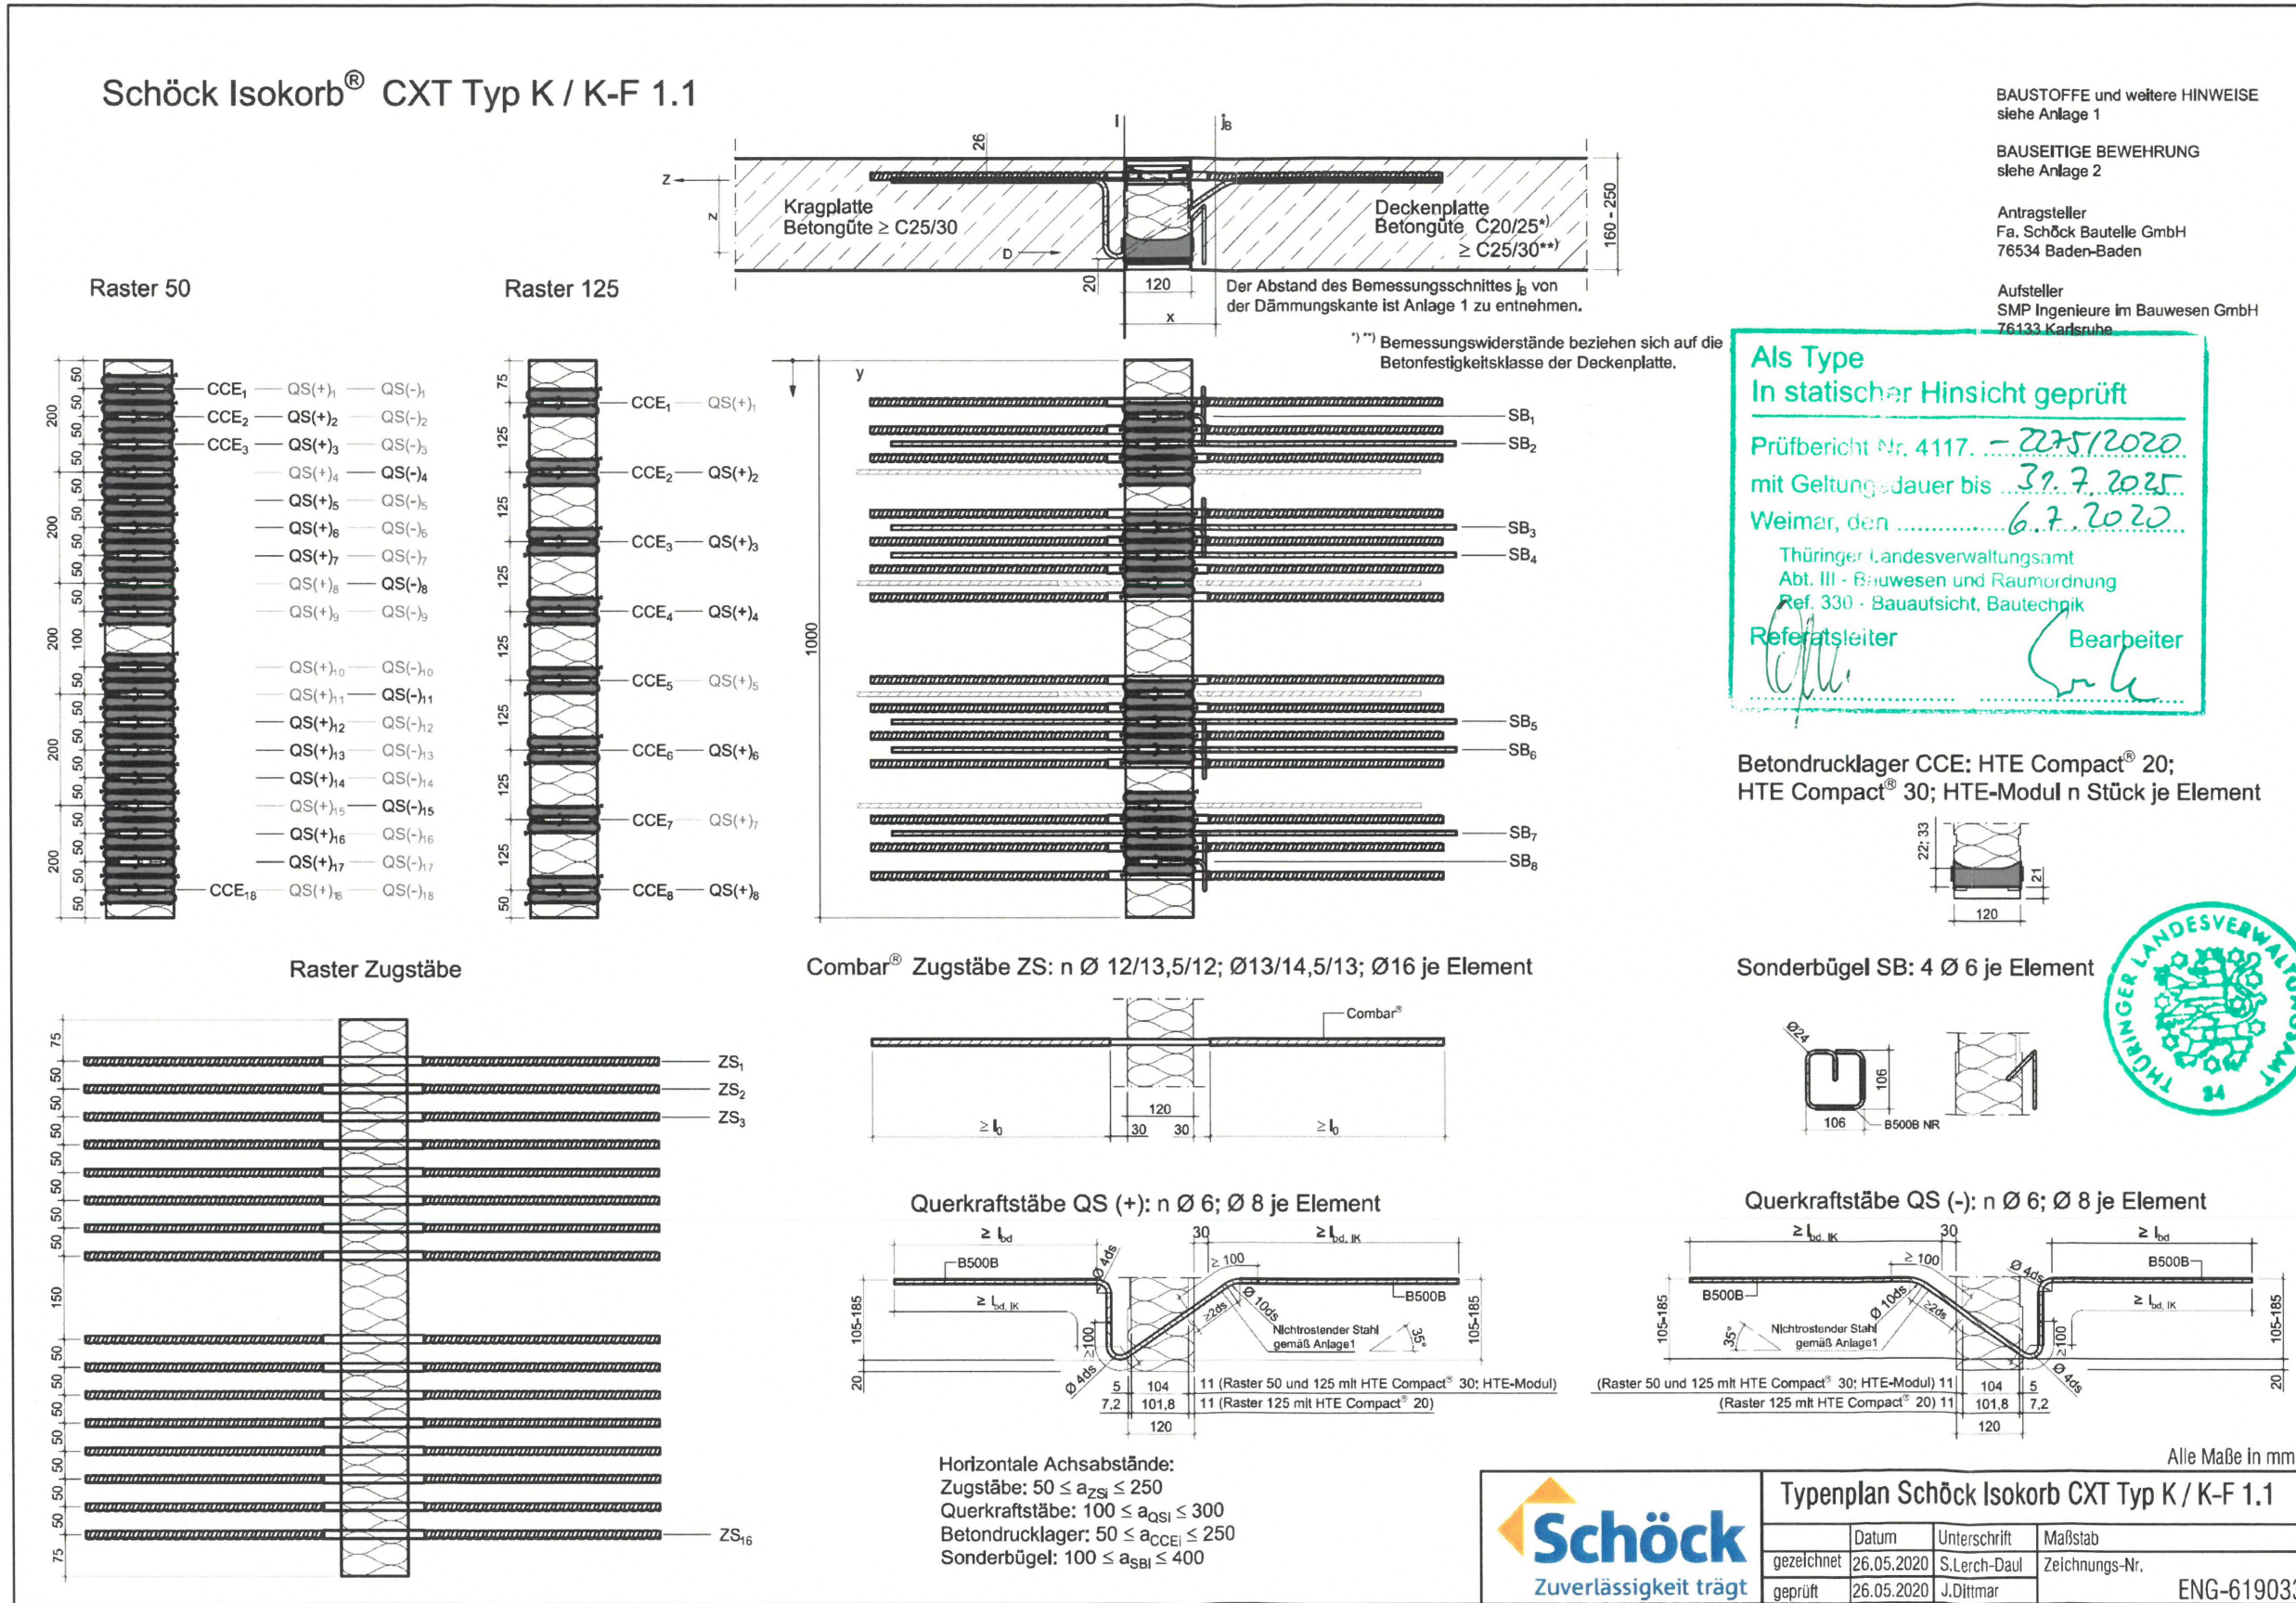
Typenplan Schöck Isokorb® CXT Typ K & K-F
